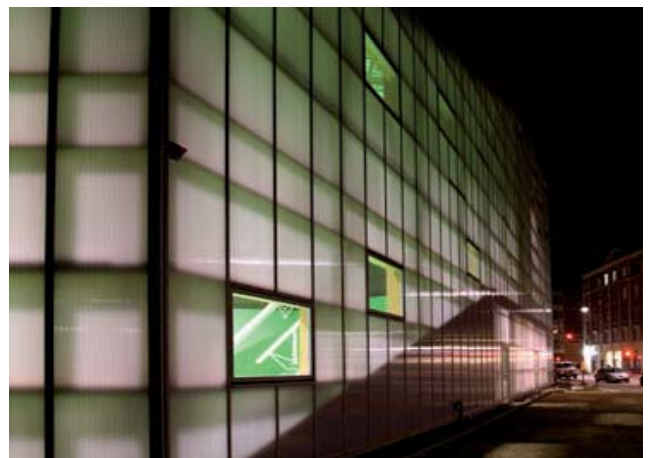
Transluzente Sandwichfassade mit horizontaler Holzunterkonstruktion innen und vertikalen Klemmleisten außen
